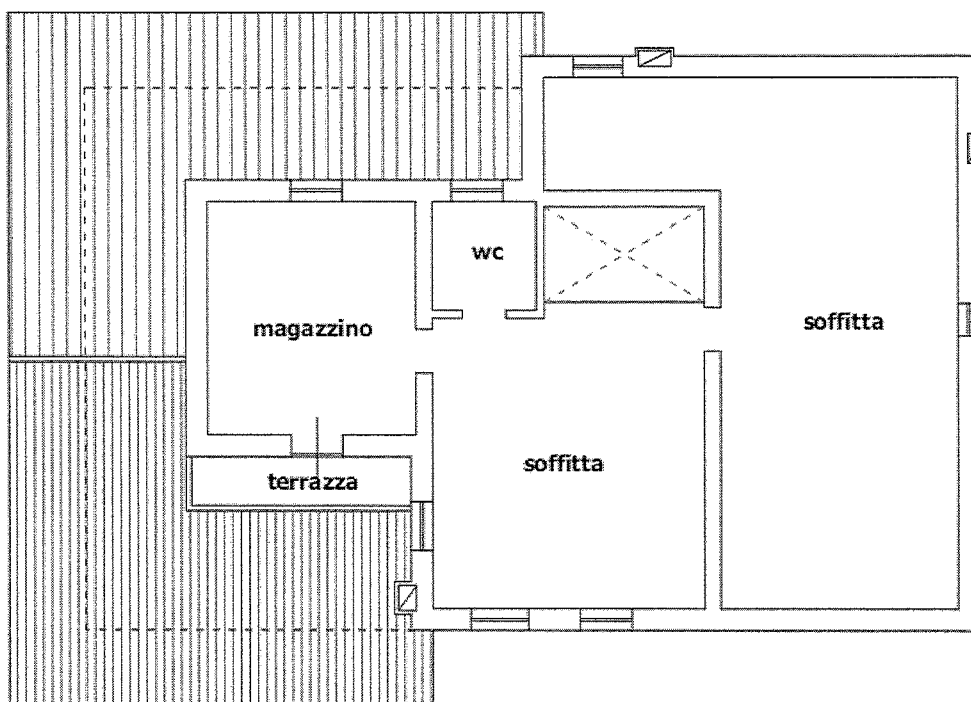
pianta piano primo/sottotetto AUTORIZZATO (fuori scala)
